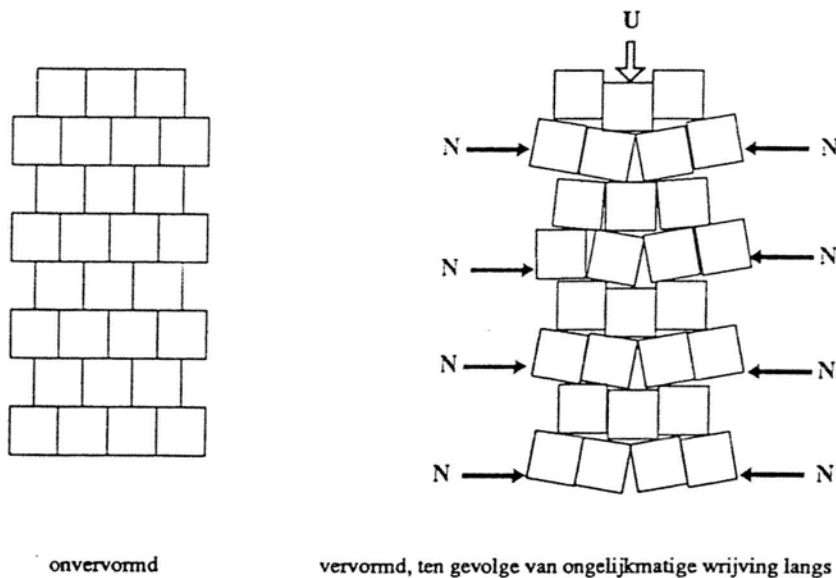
bovenaanzicht van een steenzetting, 'opgesloten' in de langsrichting van de dijk met behulp van betonbanden
